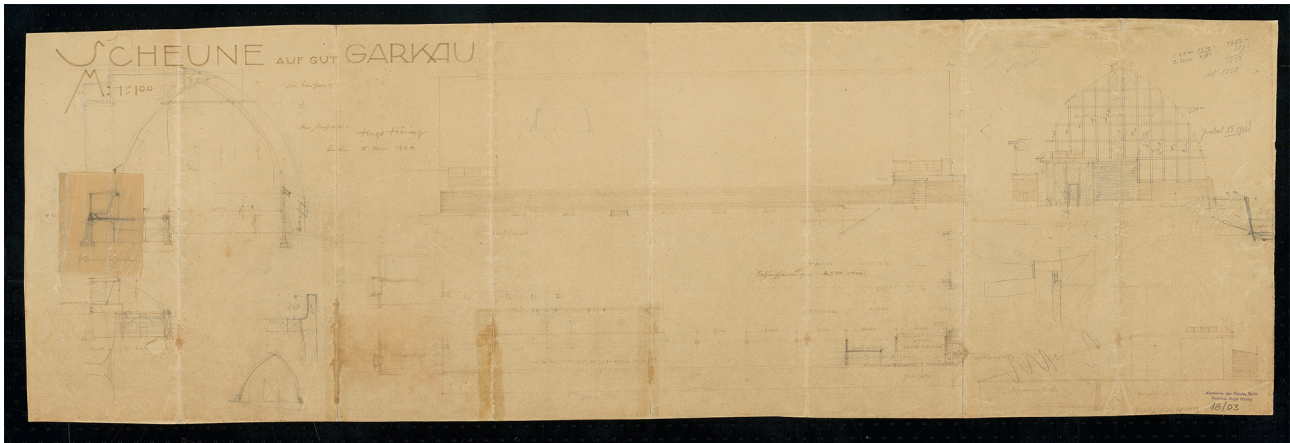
Planta baja, alzados y sección, Häring-Hugo_I204_018_003-1024w, Akademie der Künste, Baukunstarchiv, Berlin.
